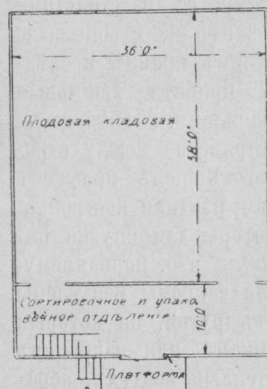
Планъ плодохранилища на тысячу боченковъ.
